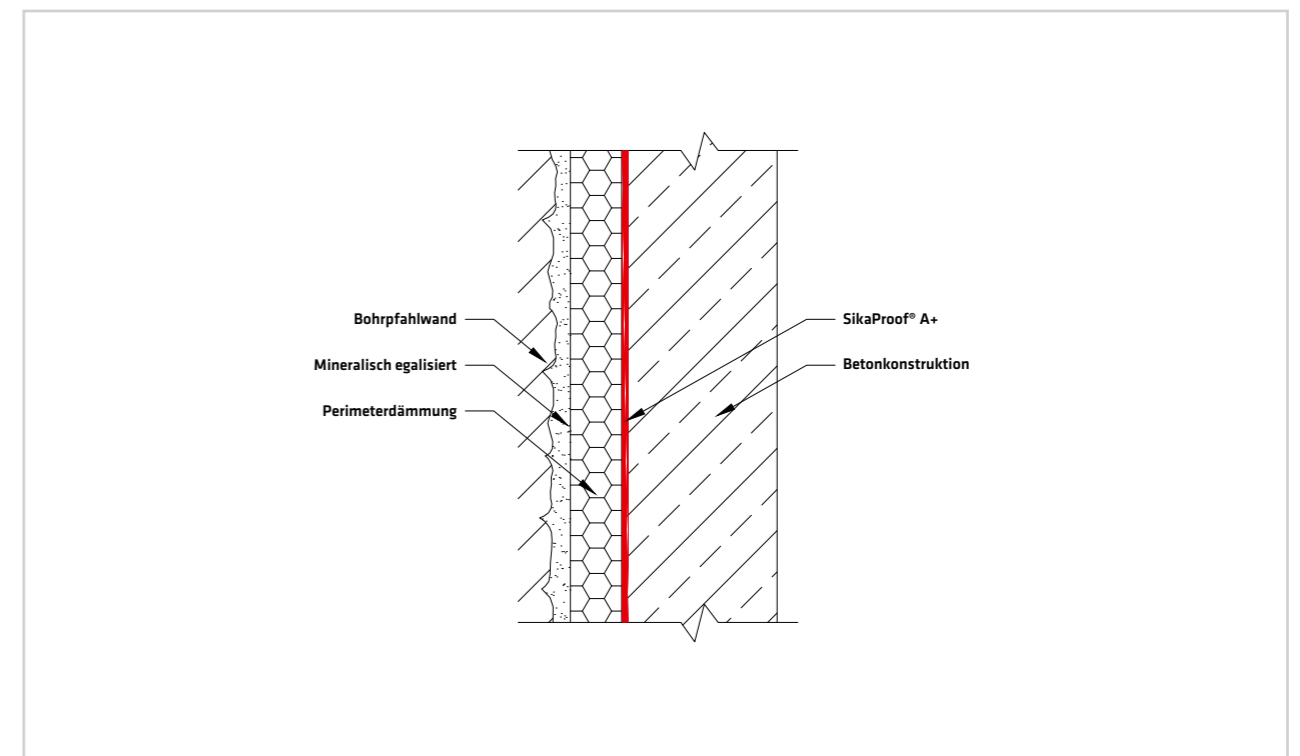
Einhäufig geschalte Wand mit Schutzlage
